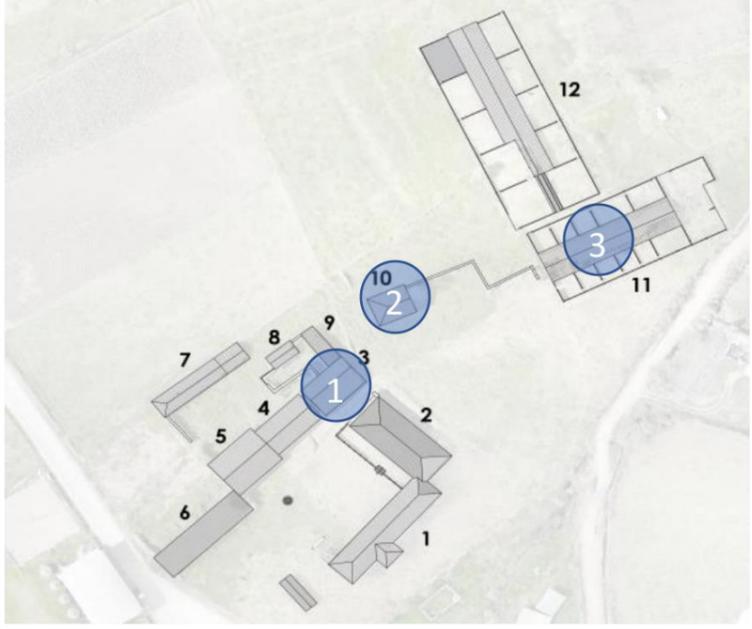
Ficha de Patologías de Techo (Cubierta). Fuente Luis Segovia 2023
